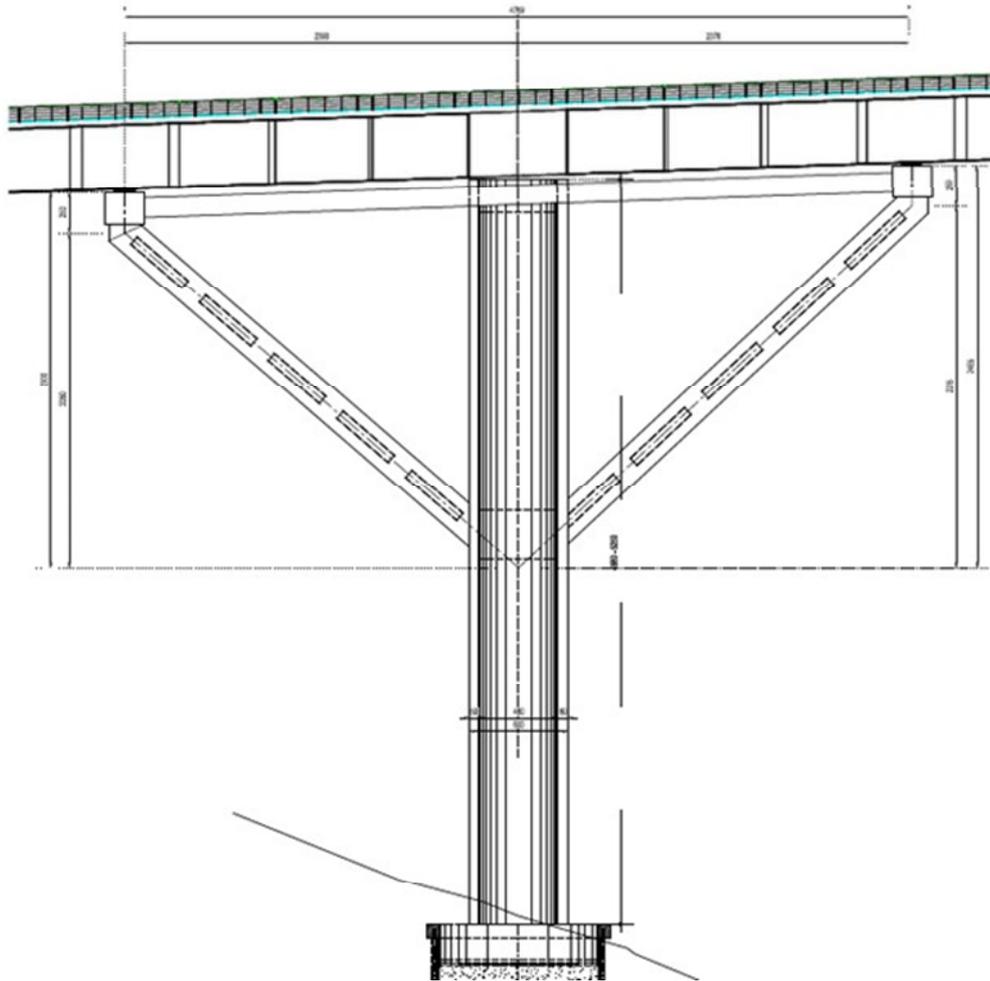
Fusto Pile – Sezione longitudinale su pila
